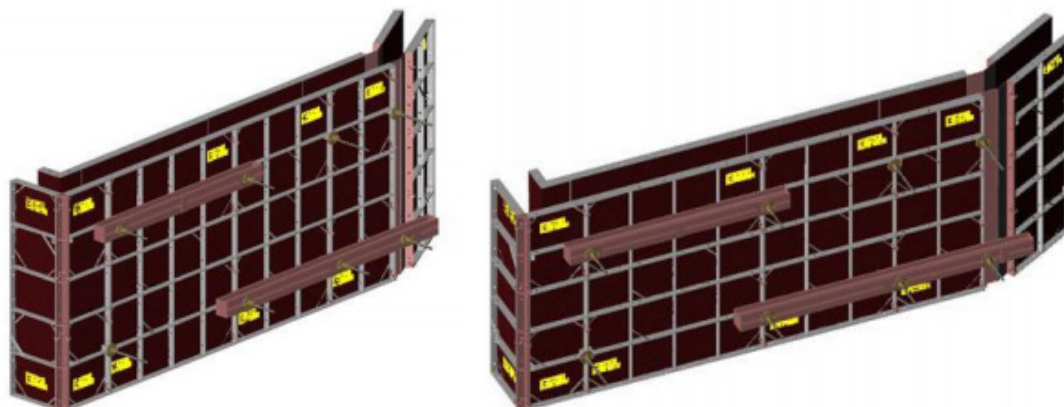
Общий вид мелкощитовой опалубки в собранном виде
